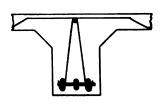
Eiseneinlage nach DICKERHOFF & WIDMANN.
